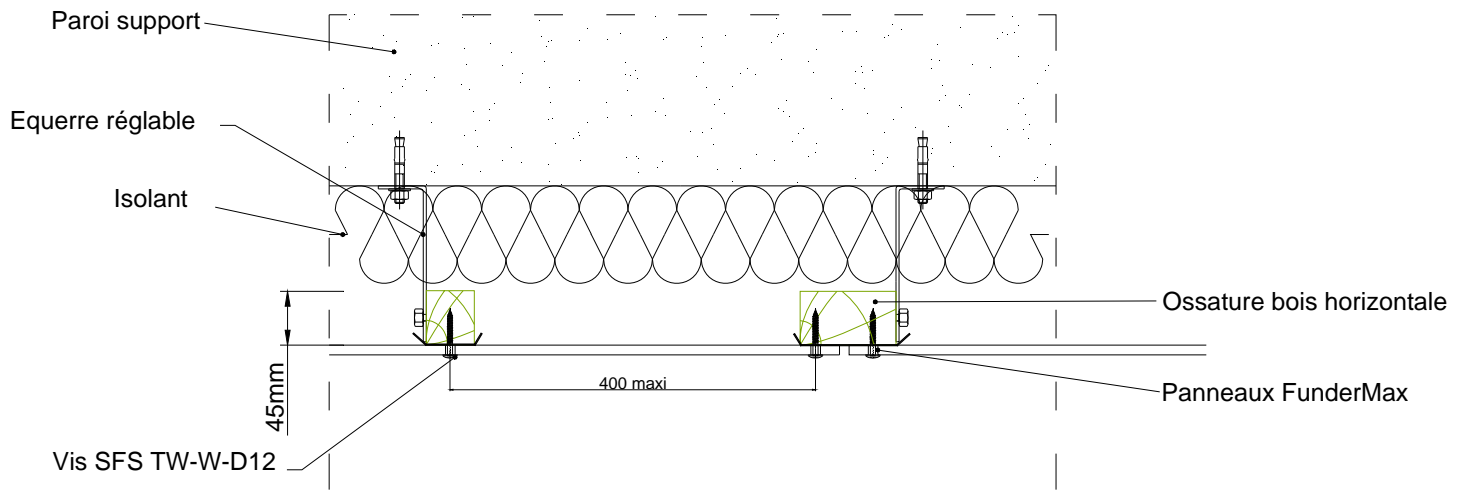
Pose en sous-face – Coupe verticale avec isolant
